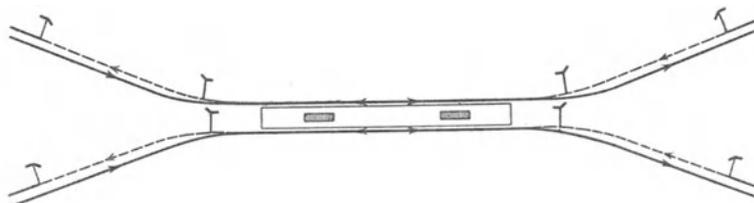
Berührungsstation. Zweigeschossige Anlage mit Richtungsbetrieb.
